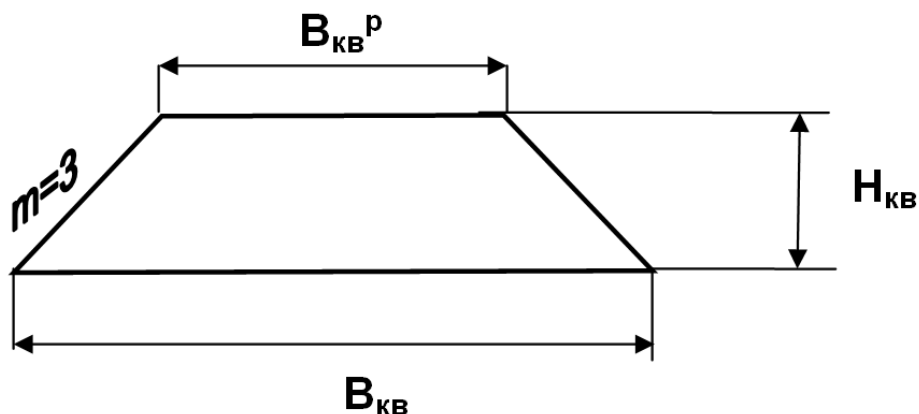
Поперечное сечение кавальеров плодородного и минерального грунтов
